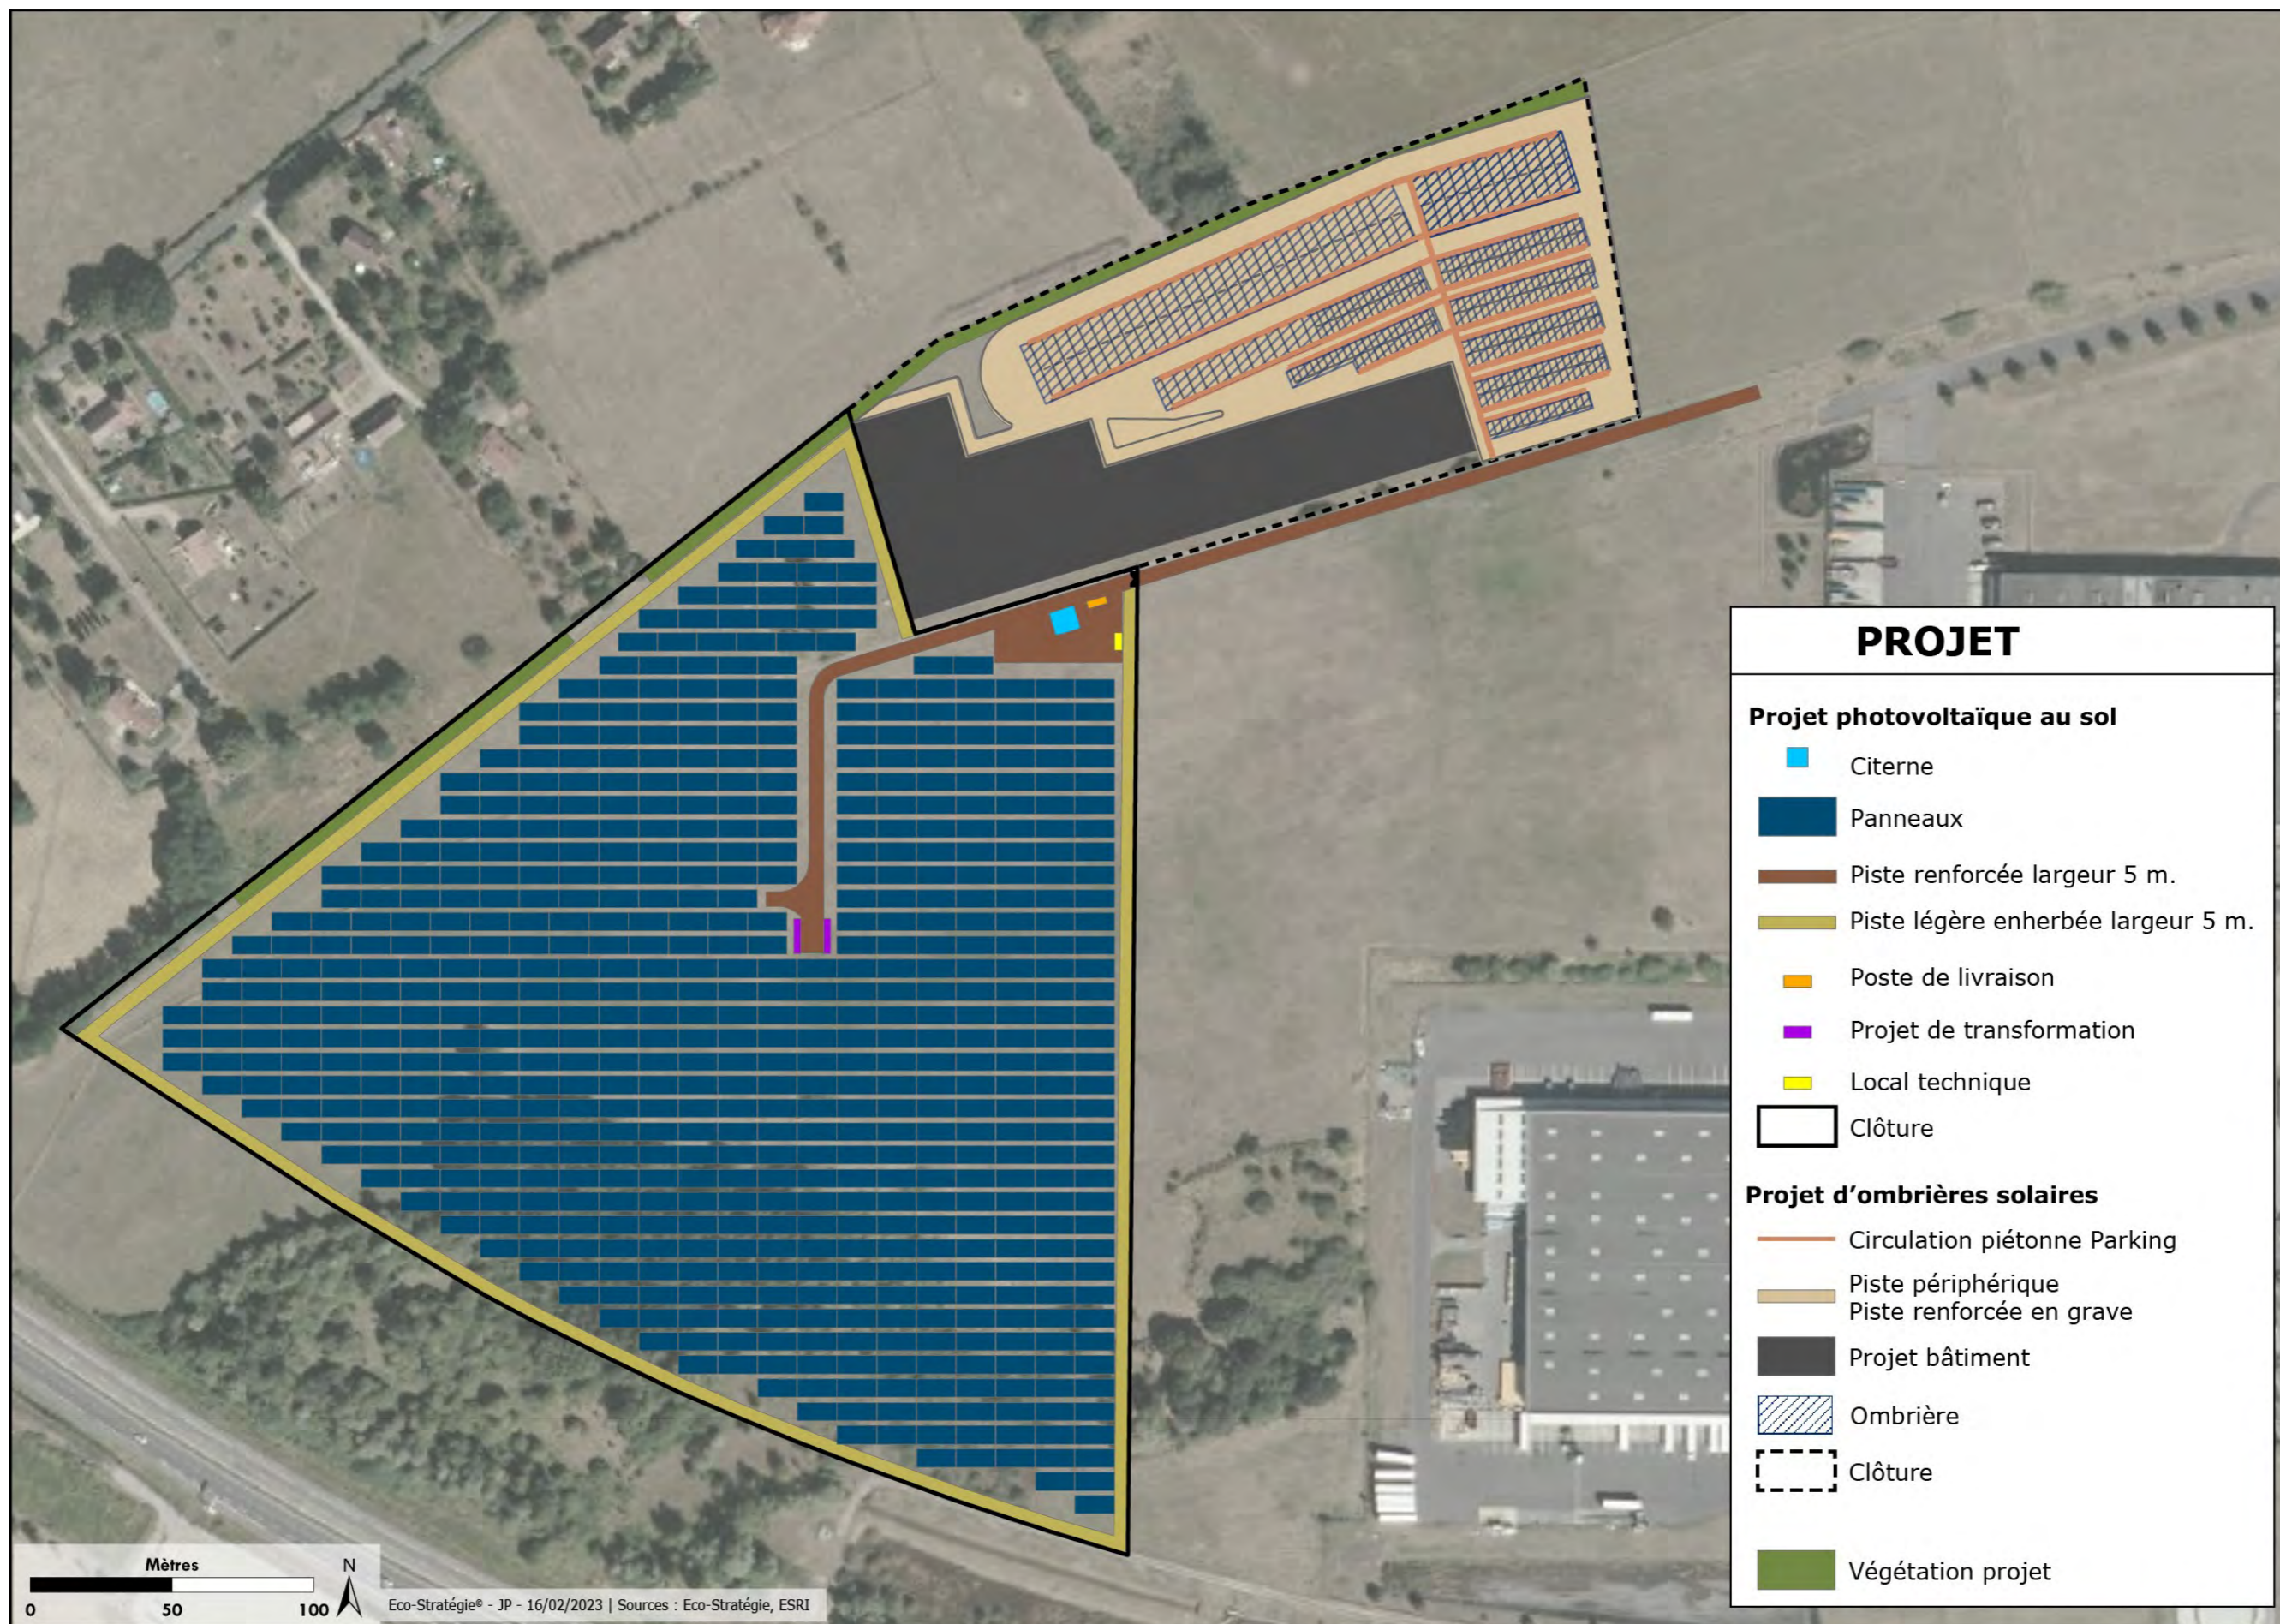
Plan de masse du projet de centrale au sol d’Avernès
